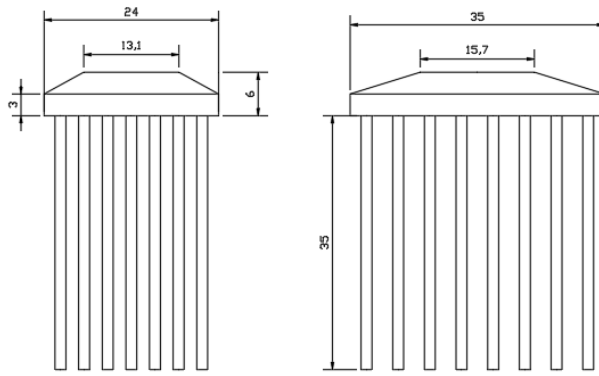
cimentación Pila 2. Alzado, planta y perfil
